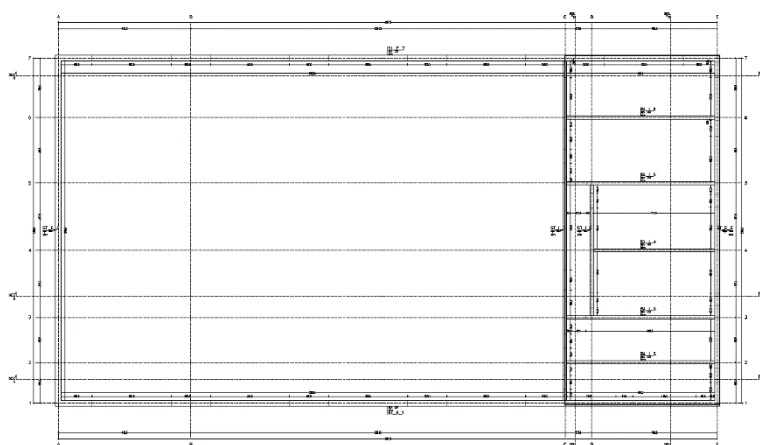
Pianta setti copertura palestra: strutture in progetto
